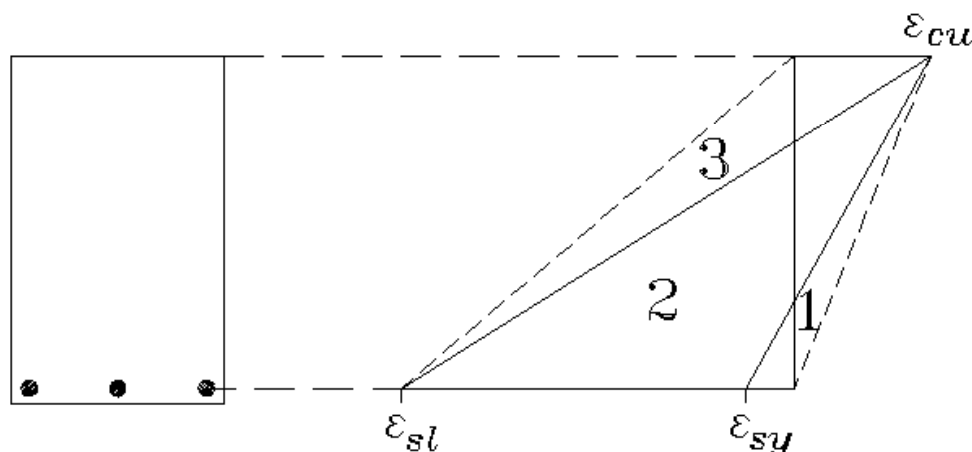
Meccanismi di collasso per flessione delle sezioni in cemento armato
